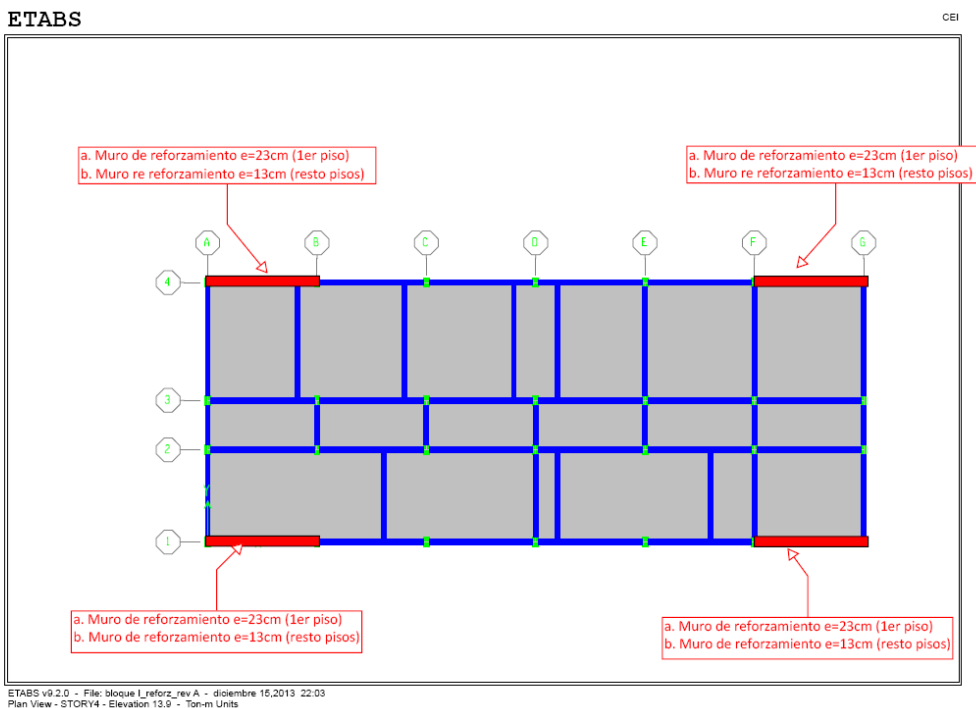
Esquema de reforzamiento con muro de concreto en bloque I
